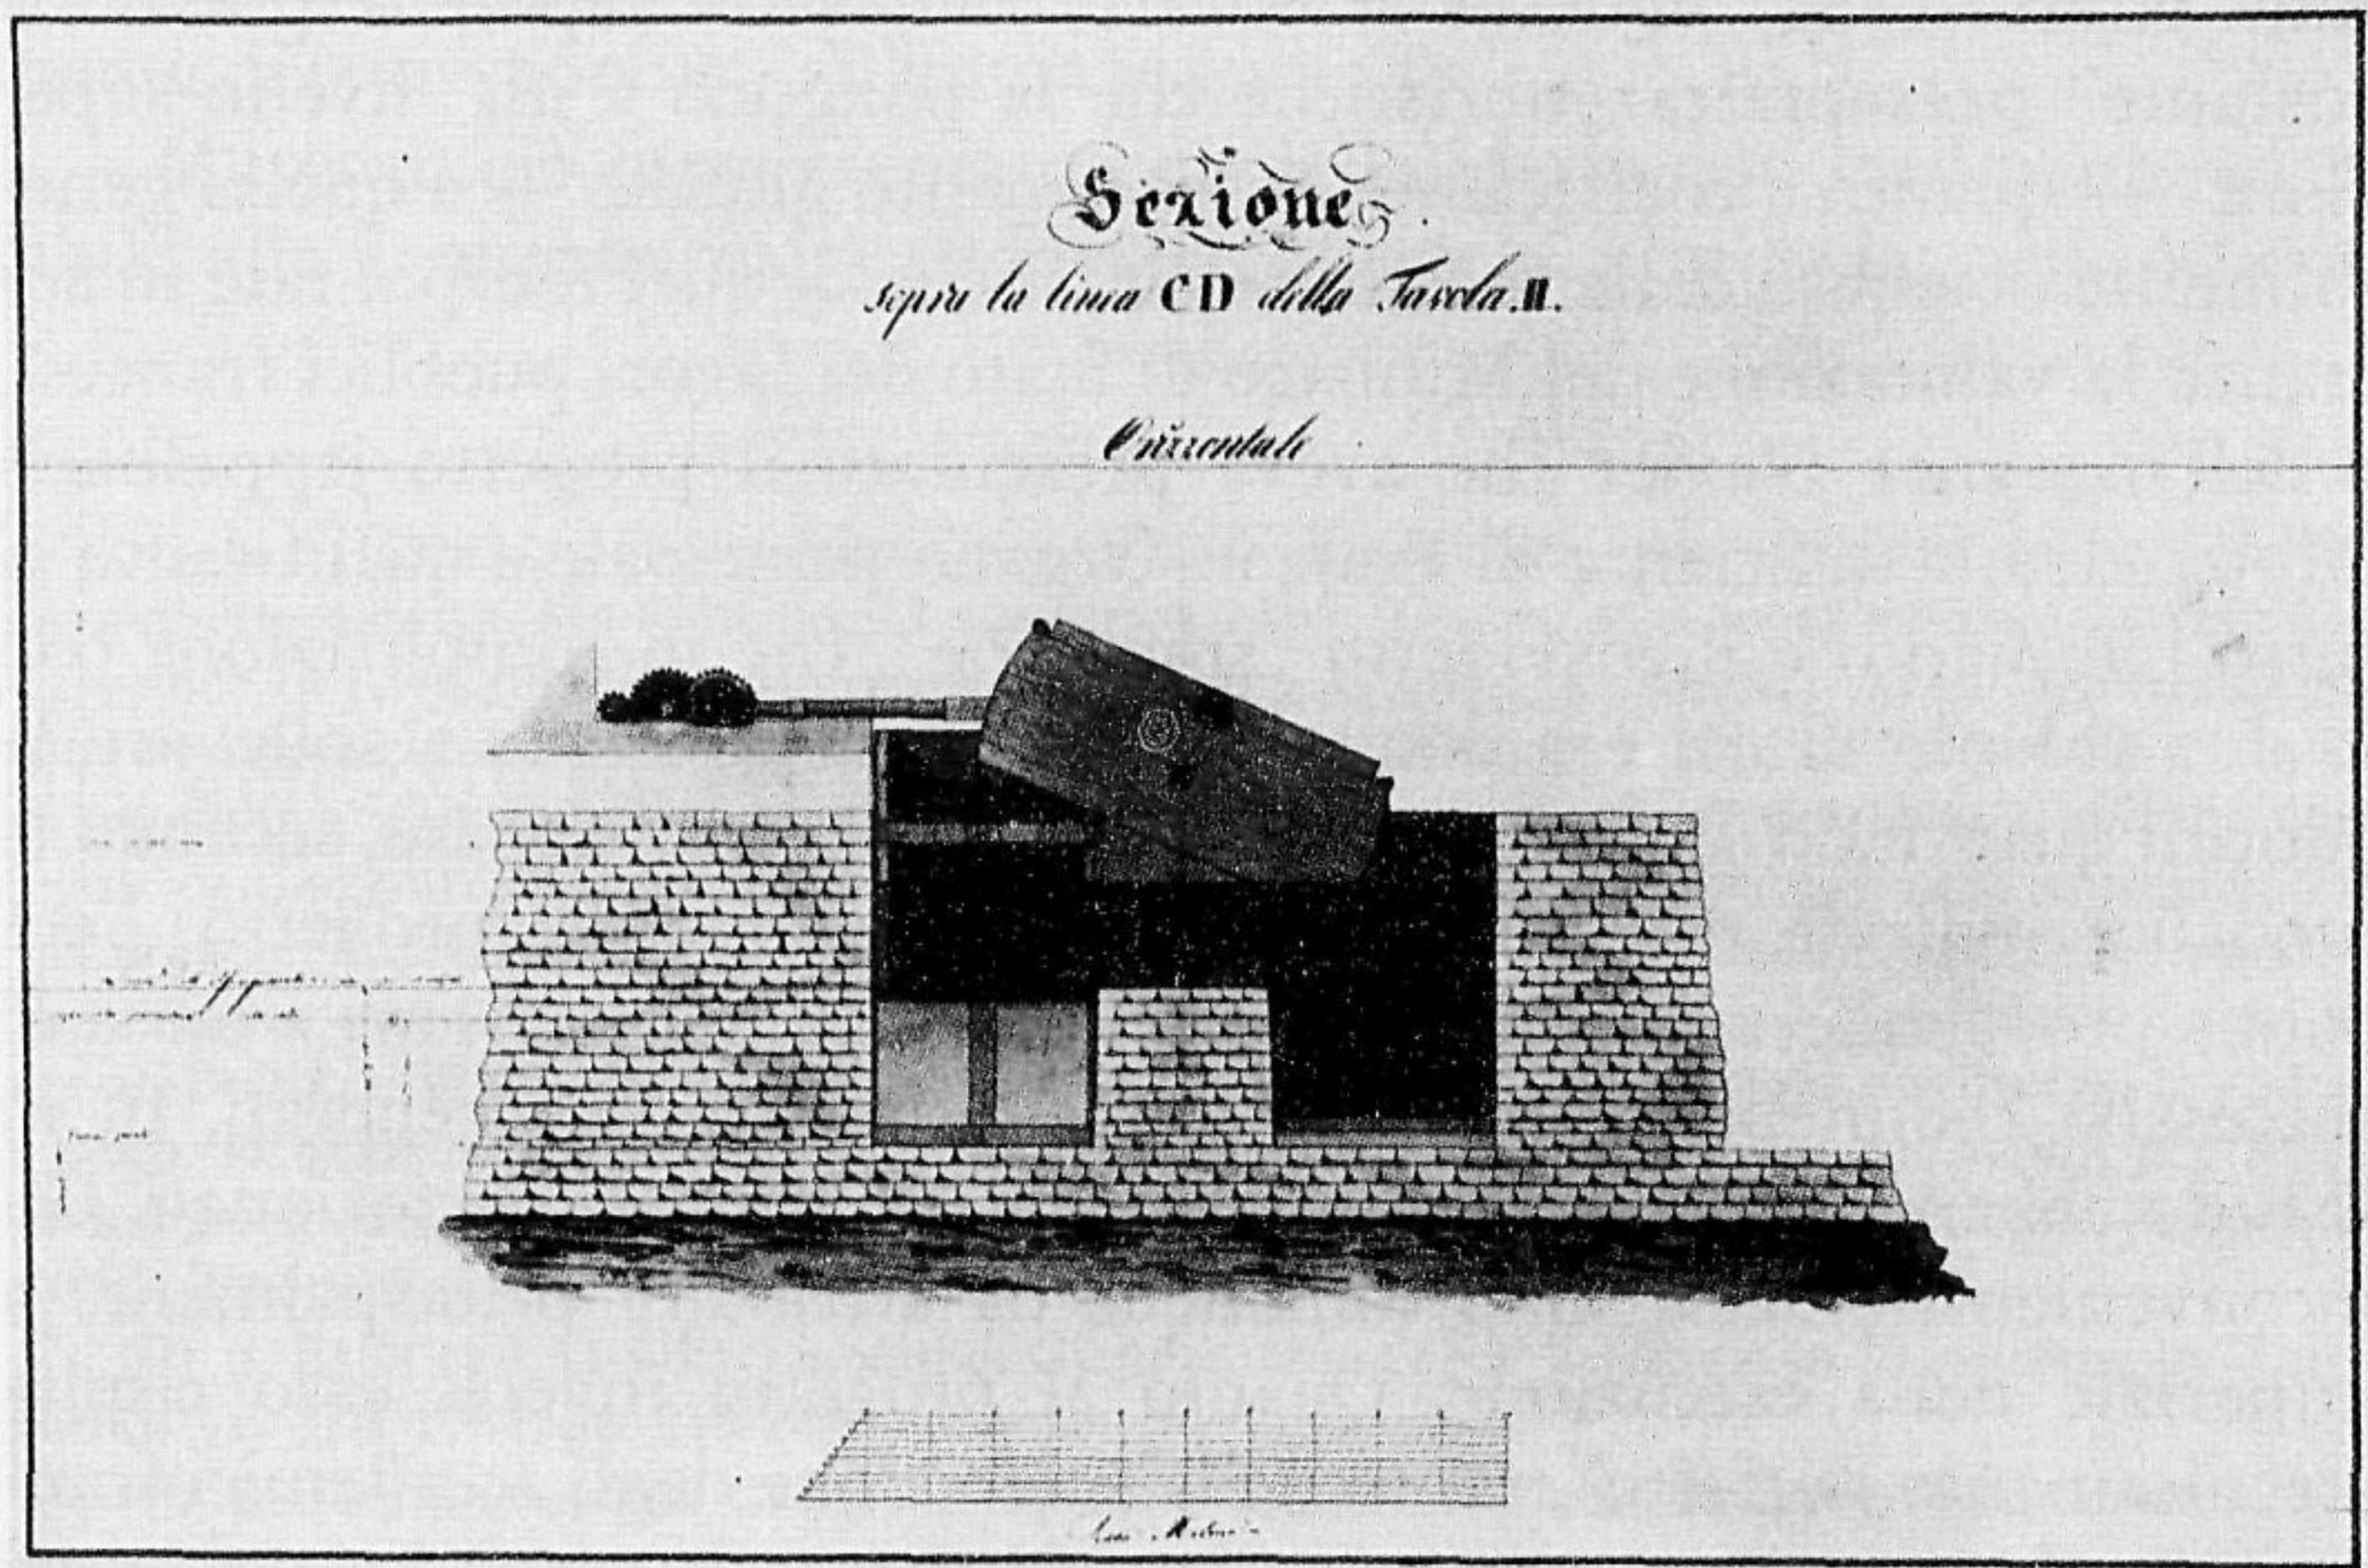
Consorzio Foresto, tavola II, sezione trasversale delle piattaforme, 1836. Padova, Museo Civico.
